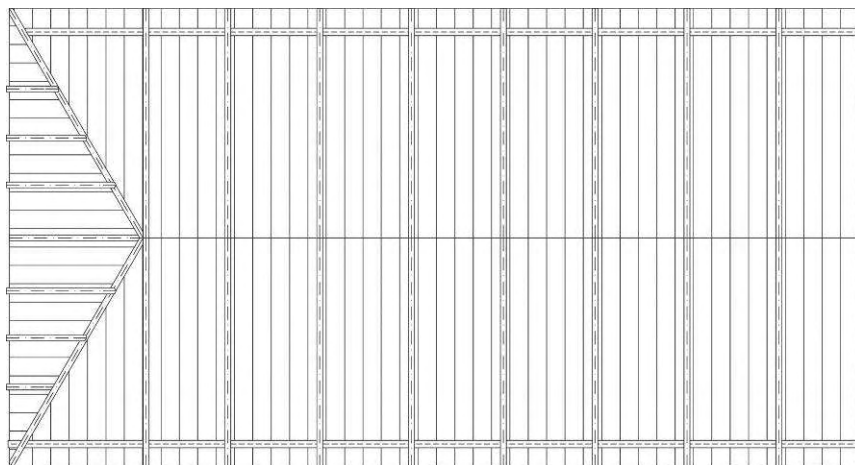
Sparrenplan Dachfläche Haupttrakt
